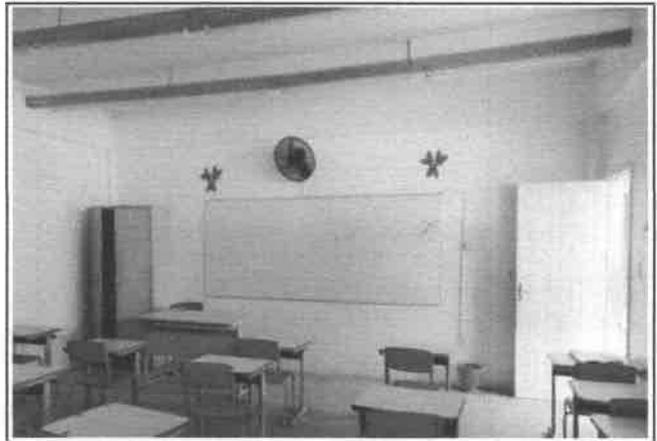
REVESTIR PAREDES SALAS DE AULA BLOCO ANEXO
